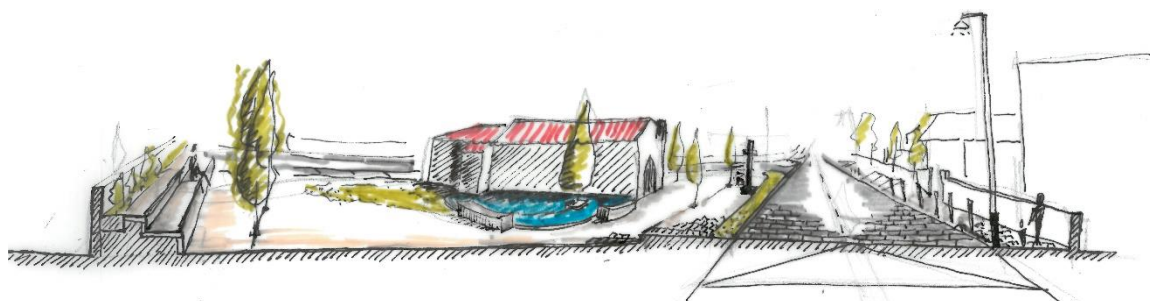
Exemplo de reabilitação da Estrada Nacional n.º 247
